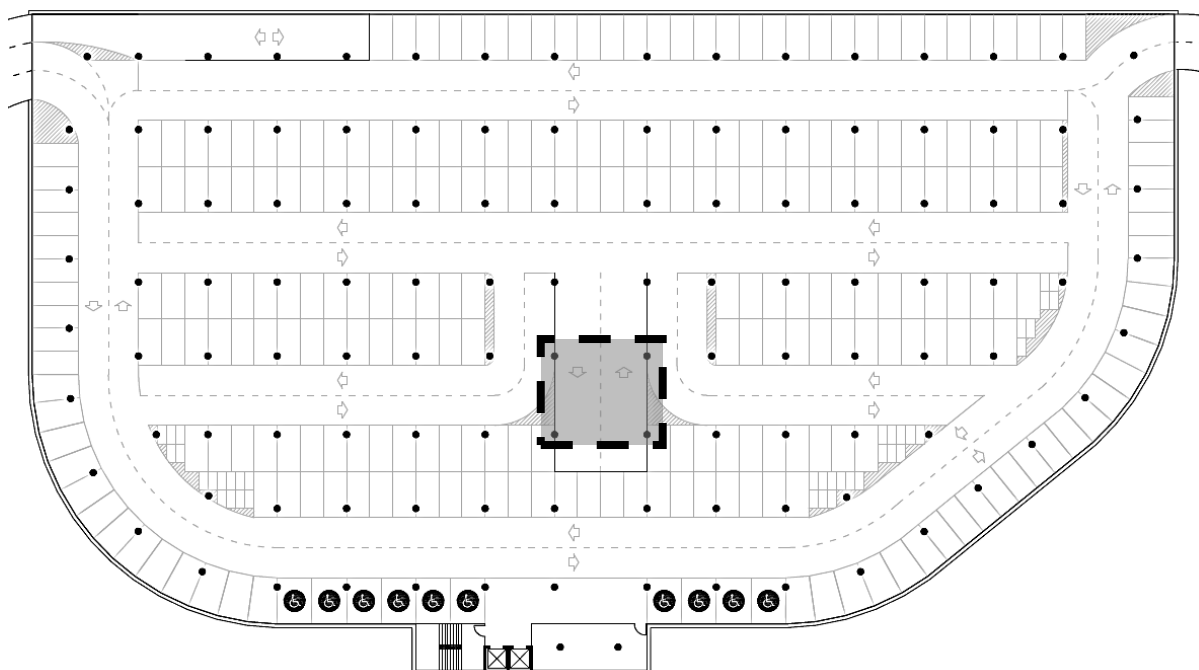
Lançamento dos pilares sobre o layout do pavimento superior
